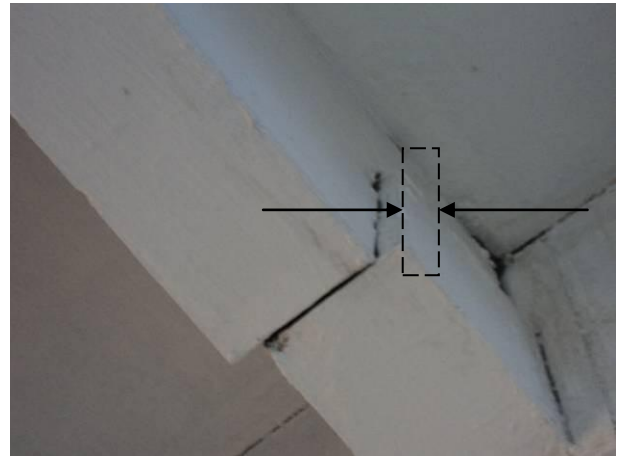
Detalhe da foto anterior ilustrando a excentricidade existente.
